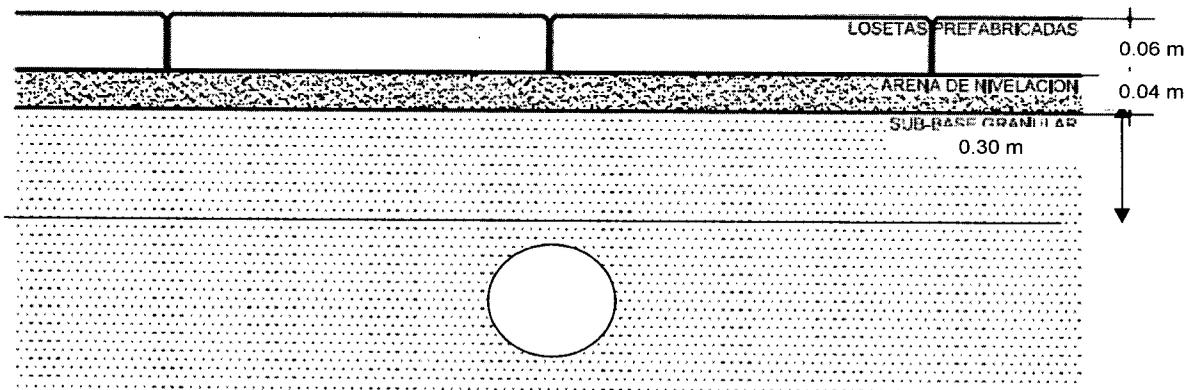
Estructura peatonal con loseta prefabricada apoyada sobre arena
